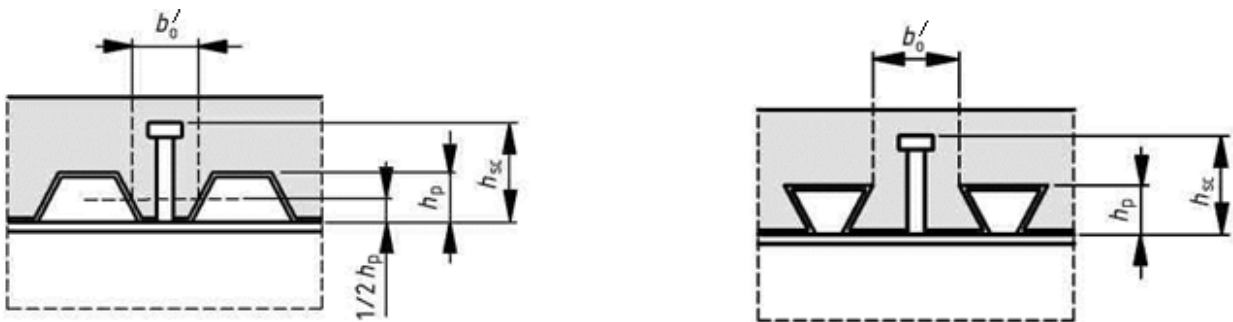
Профільований настил з гофрами поперечно балці
